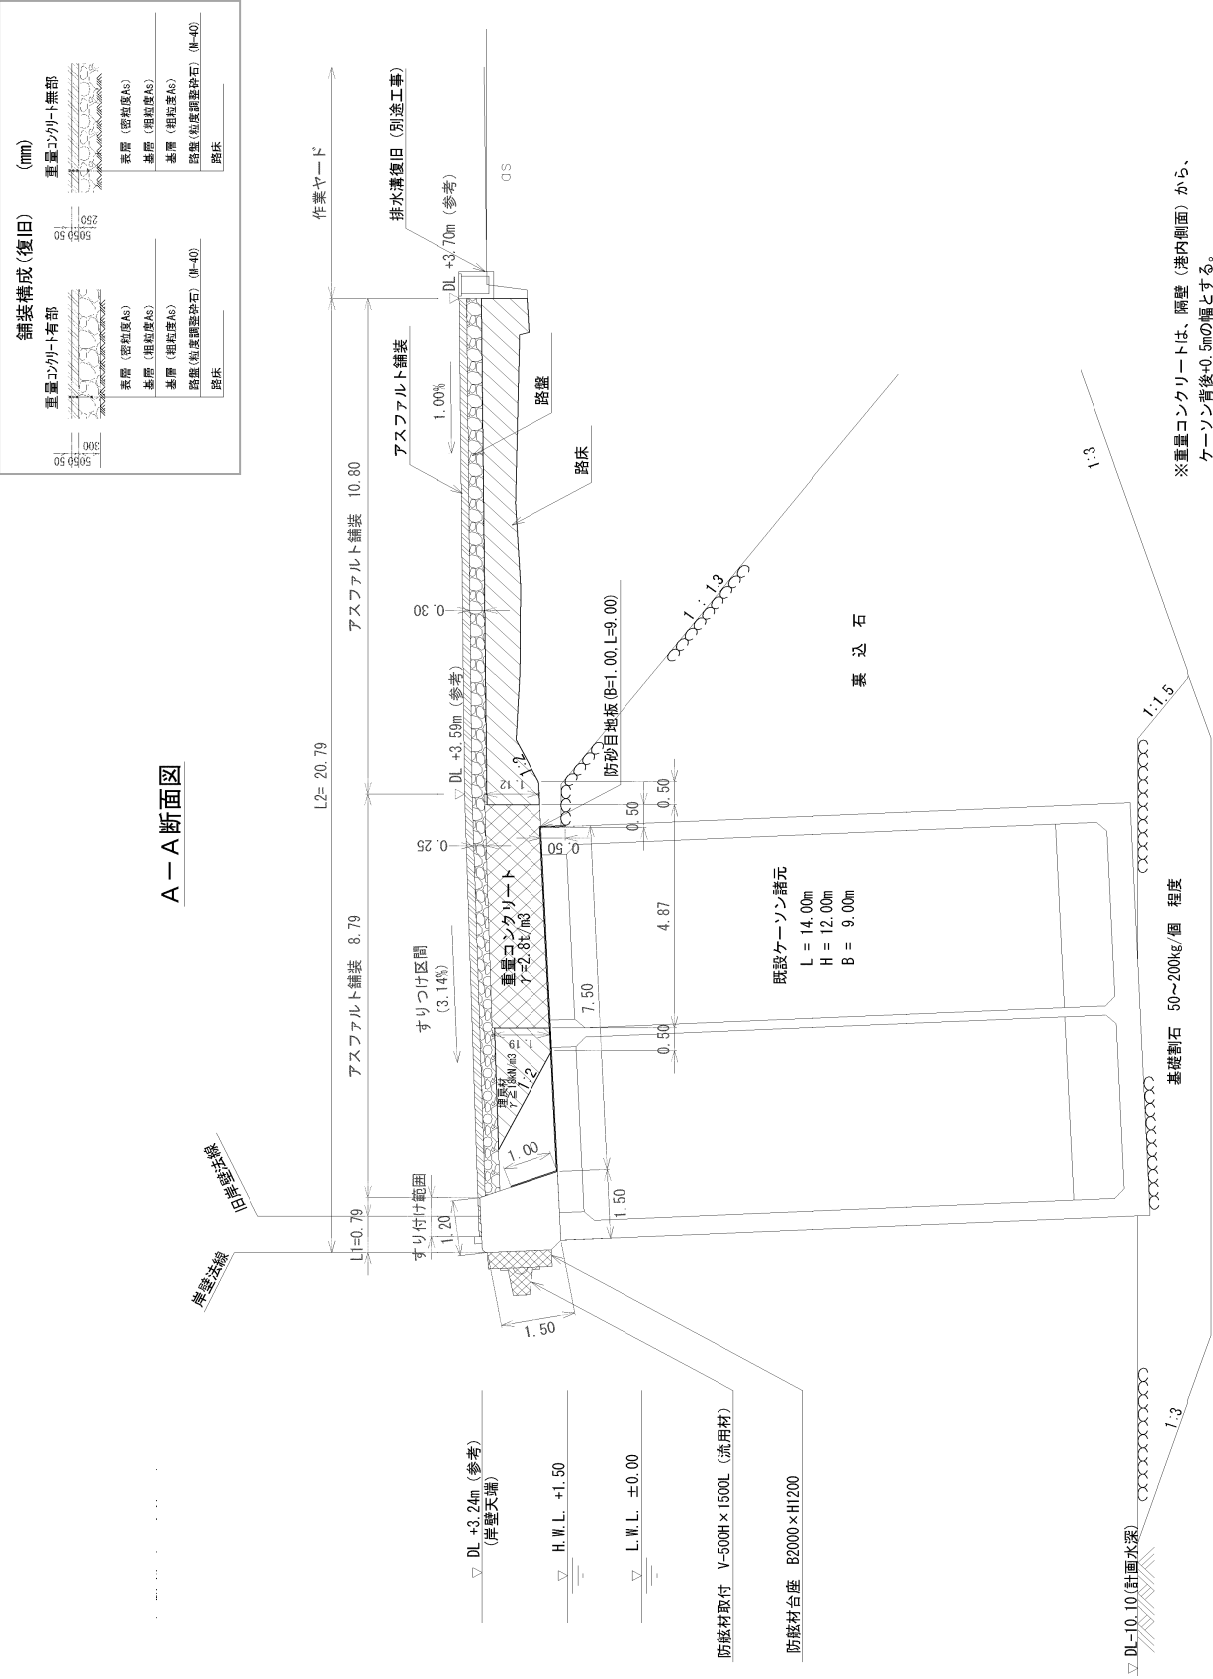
No.5 南公共ふ頭A岸壁(-10m)断面図(被災後) 撤去図A-A'
